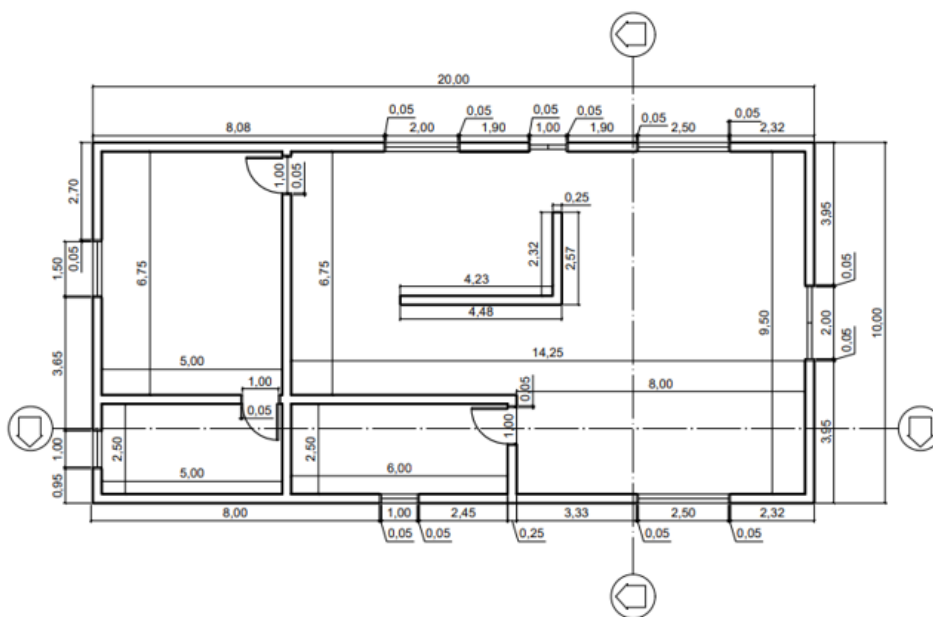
Planta baixa do projeto arquitetônico. Fonte: Os autores, 2023.
